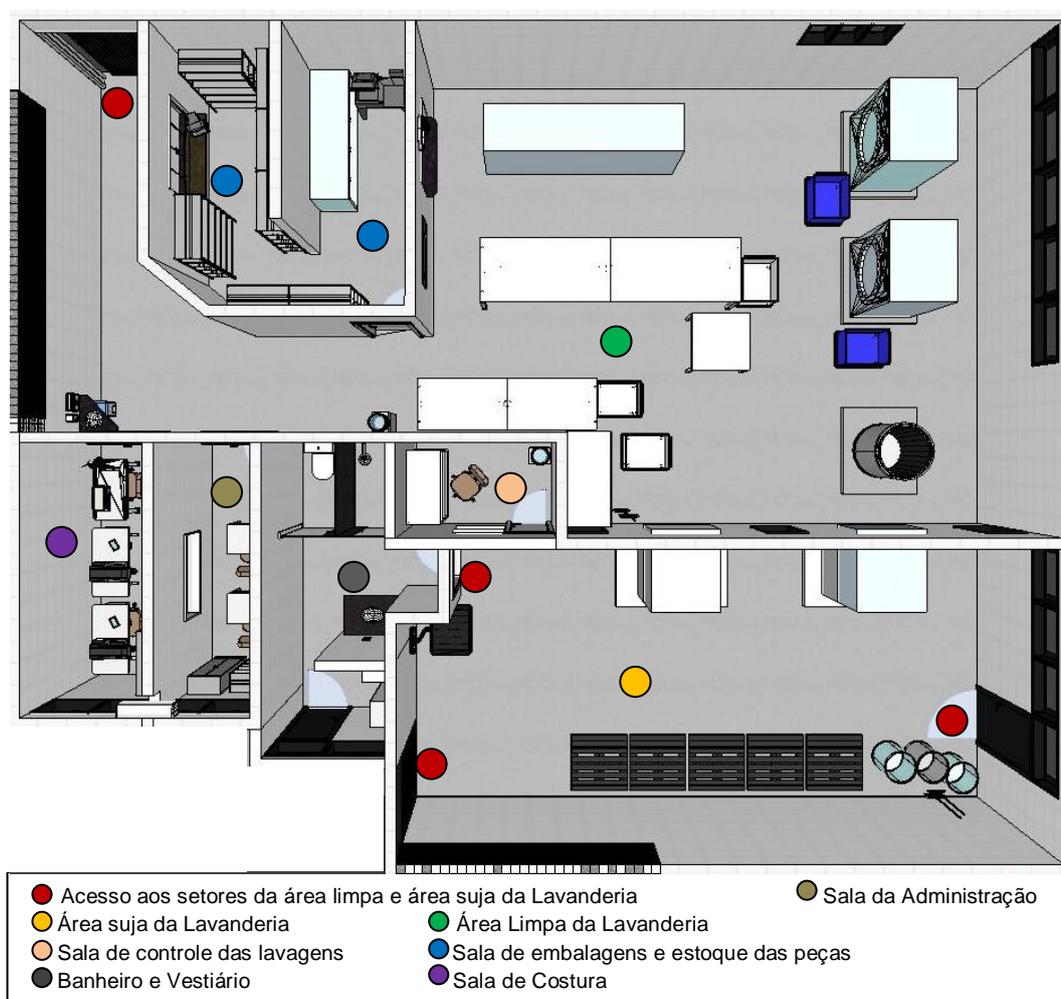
Planta baixa dos setores da lavanderia hospitalar analisada
